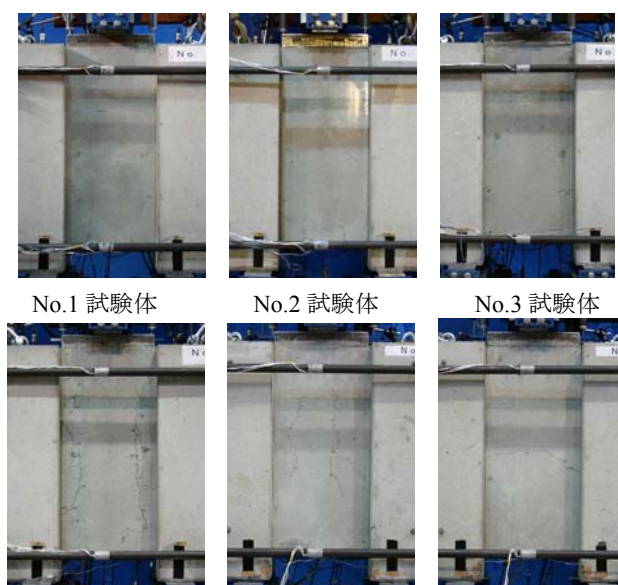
打継ぎ部ずれ量 2mm 時の破壊状況
